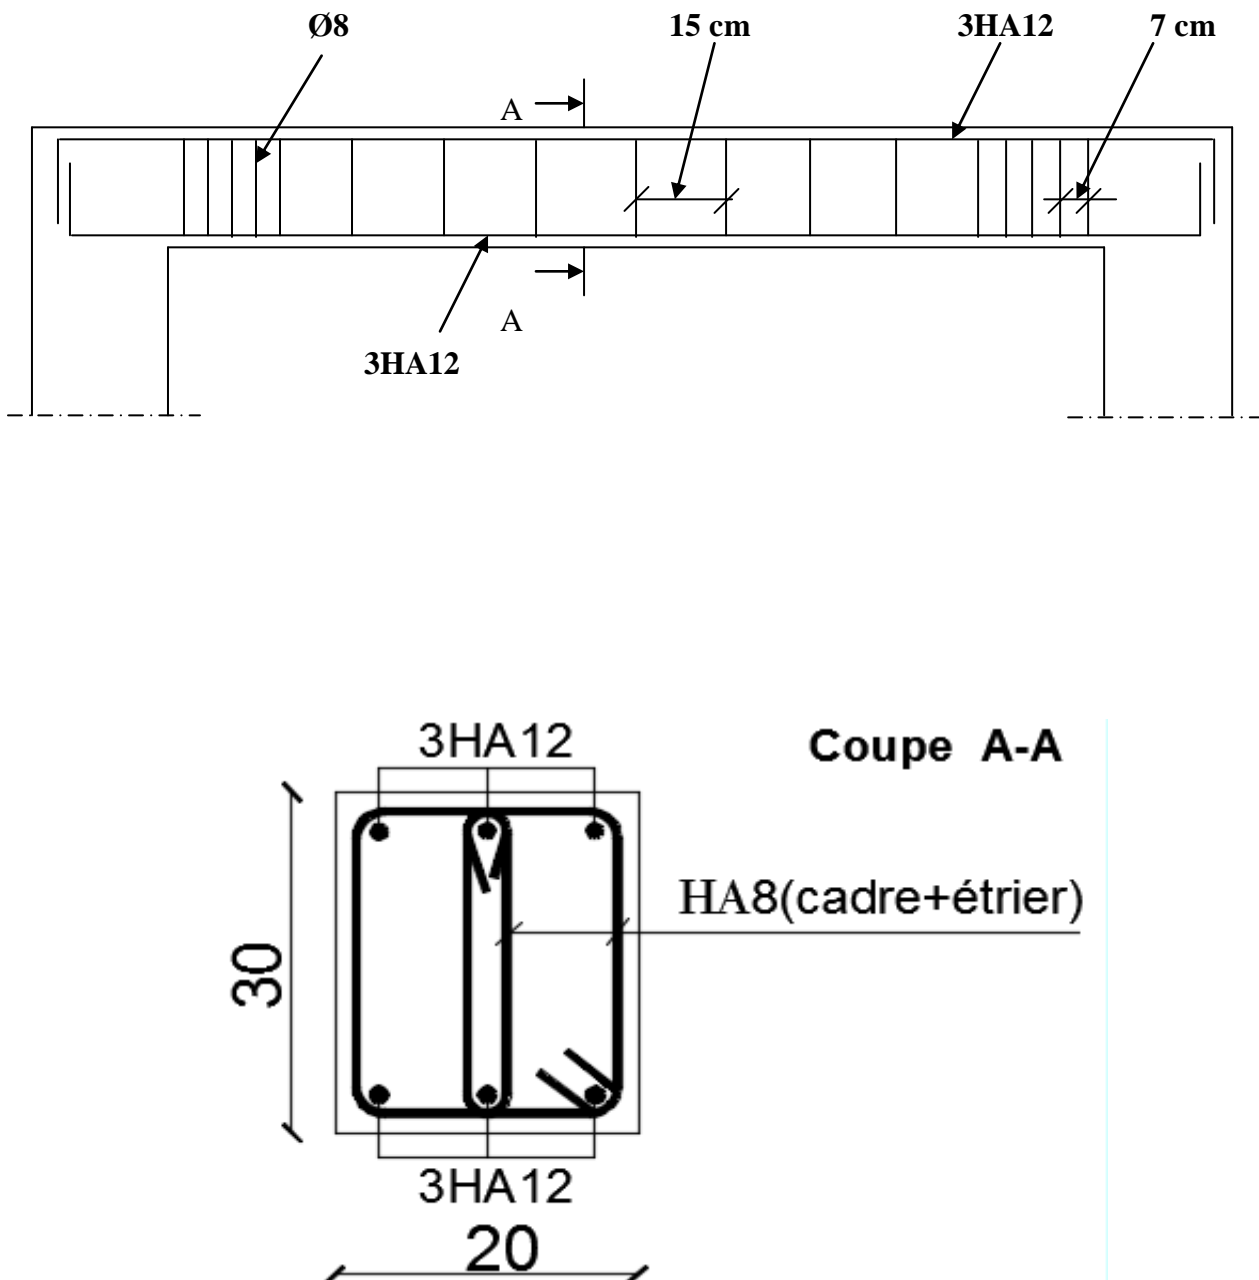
Ferrailage de la poutre de chaînage
